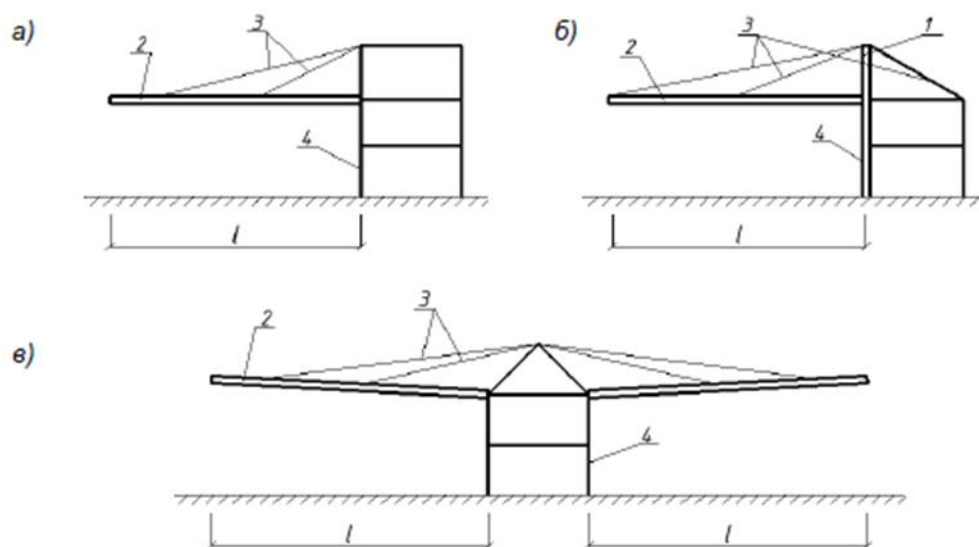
Схемы консольных подвесных покрытий: а, б – одноконсольные, в – двухконсольные; 1 – пилон, 2 – подвесная балка жесткости, 3 – ванты (тросы), 4 – каркас пристройки
